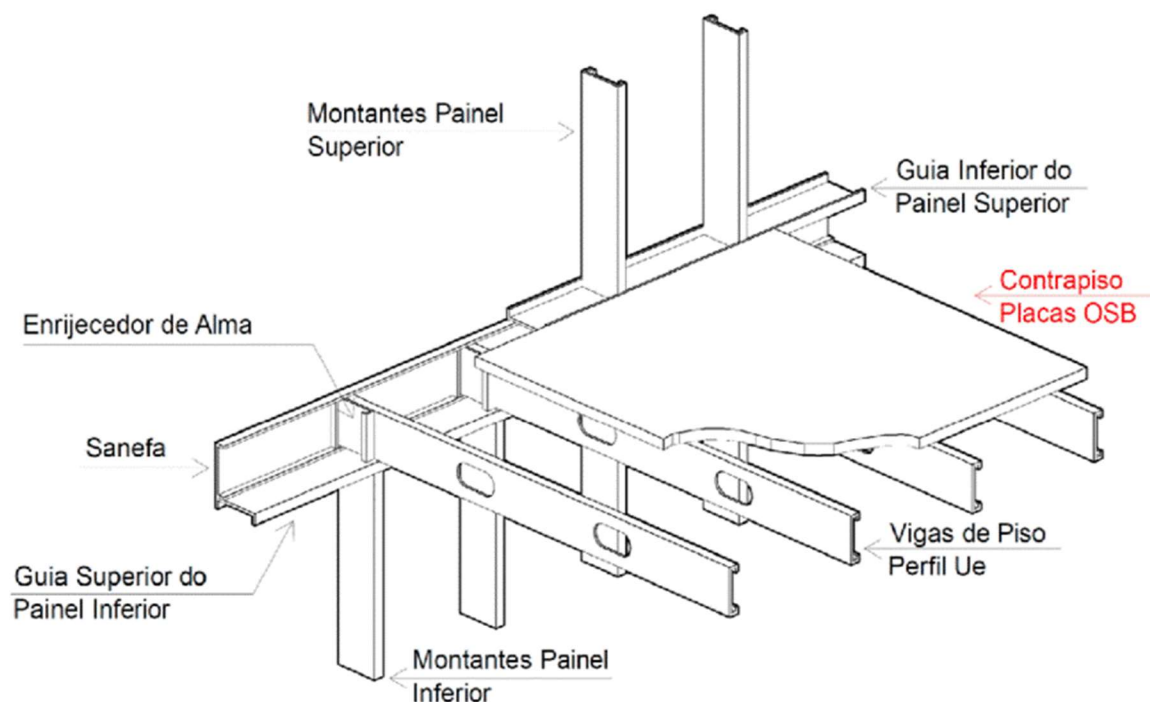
Esquema estrutural de uma laje seca em *LSF
